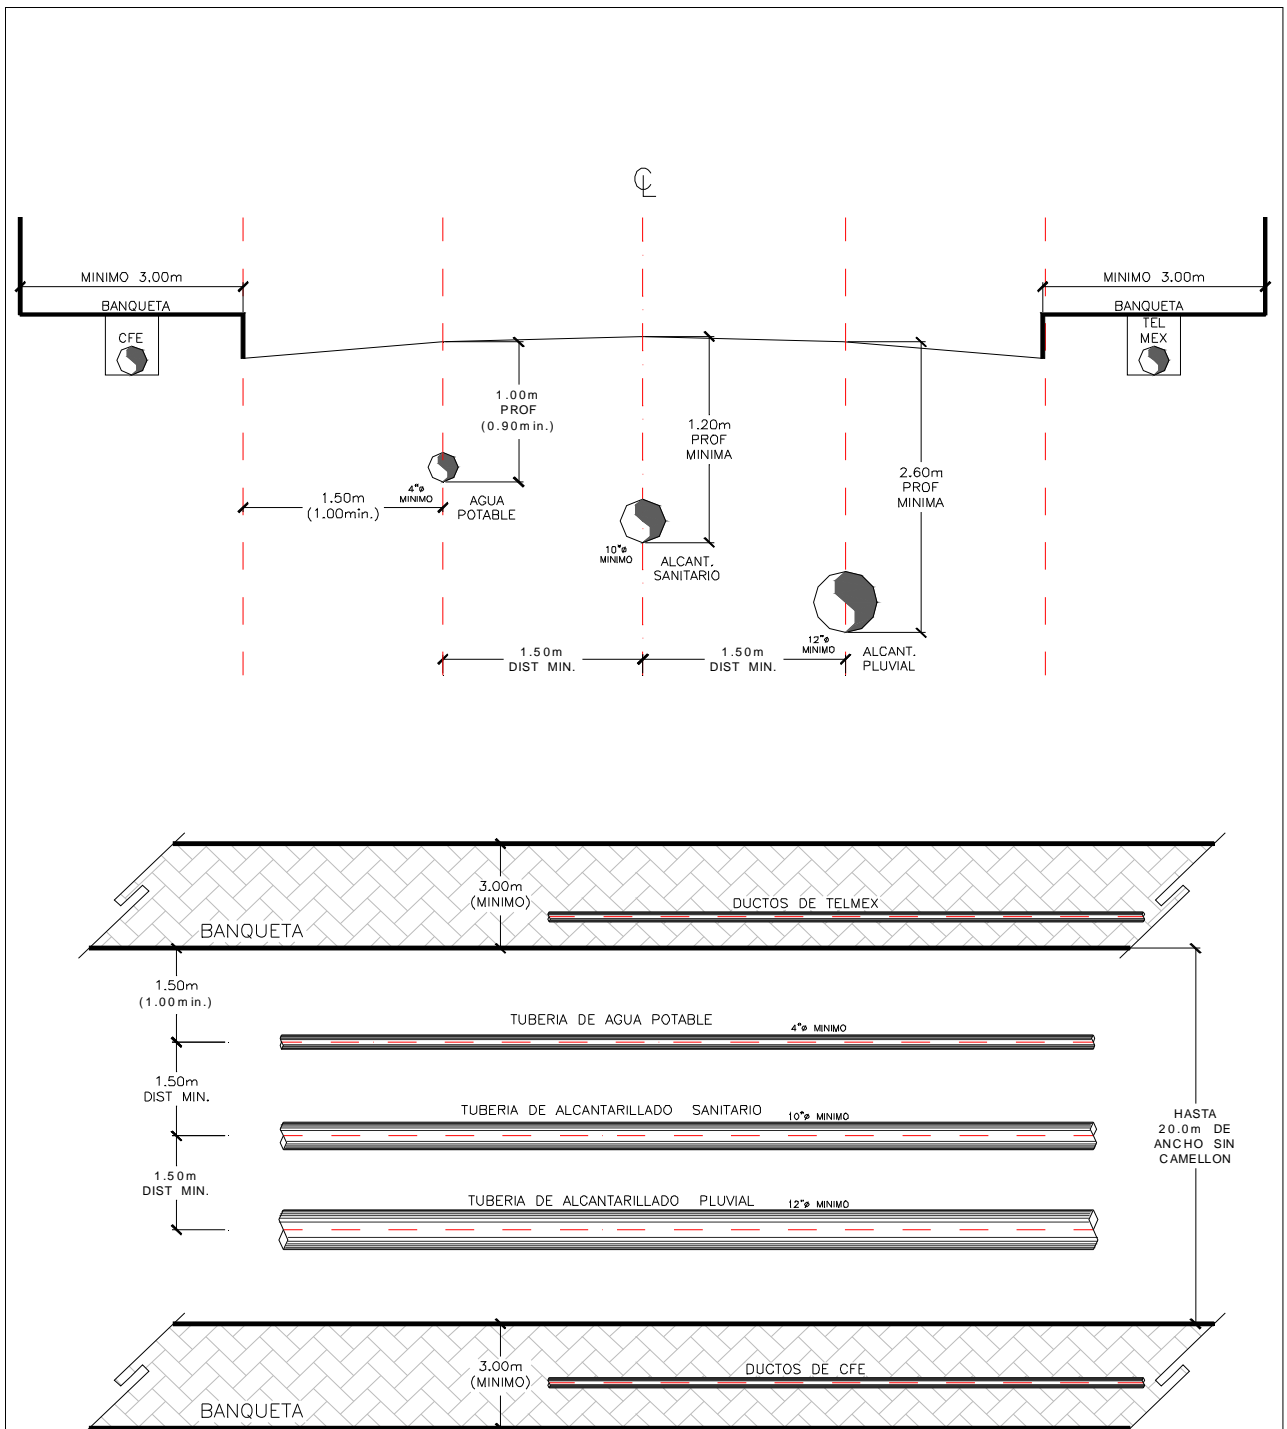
UBICACIÓN DE TUBERÍAS EN CALLES DE HASTA 20 METROS DE ANCHO CON O SIN CAMELLON.
